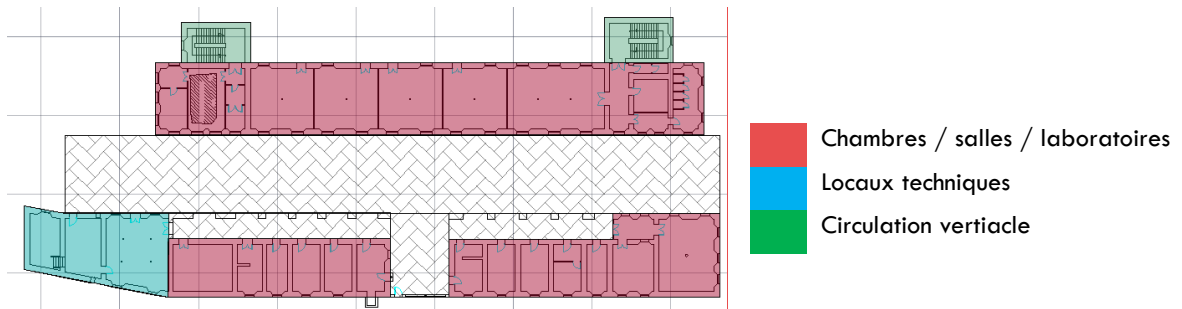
Plan de l'état actuel de l'Hôpital militaire Baudens – Niveau -1 –
